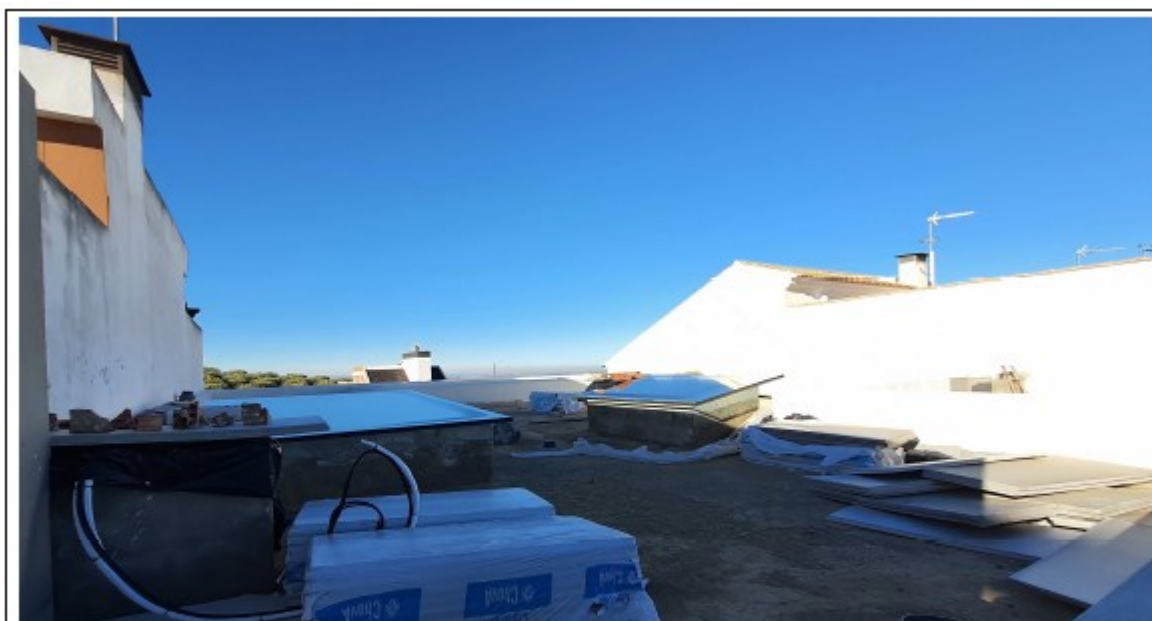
Cubierta no transitable (QNT) XPS CHOVA acopiado en cubierta
